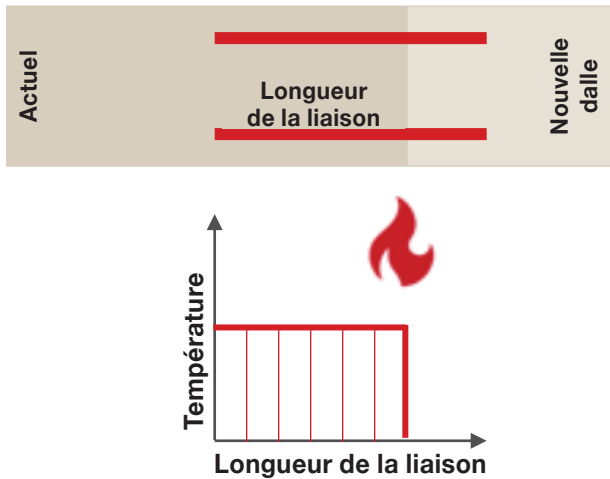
Exemple de température constante sur la longueur d'adhérence d'une barre d'armature post-installée.
